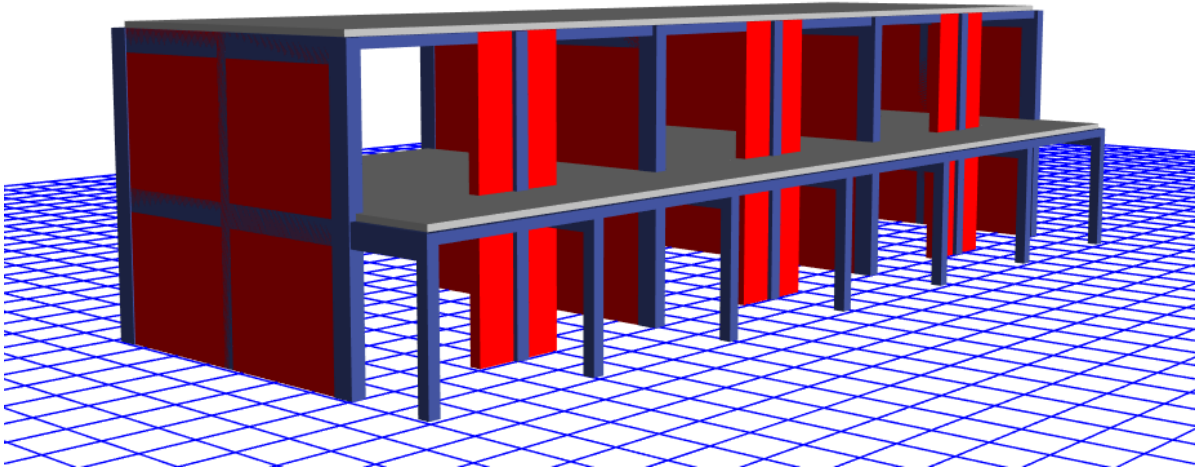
Vista tridimensional del pabellón 3 con placas de concreto armado.
